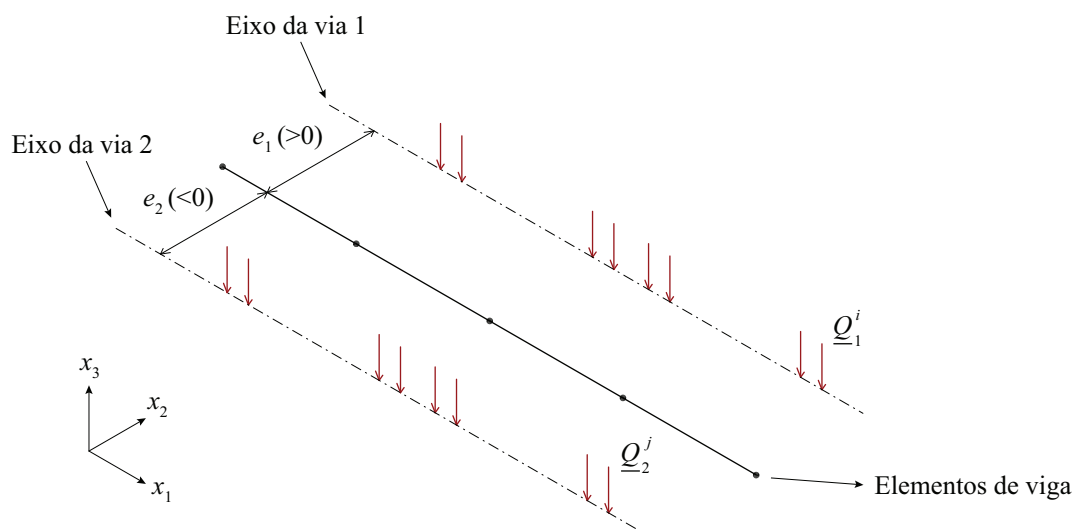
Estrutura sujeita à acção de dois conjuntos de cargas móveis.
